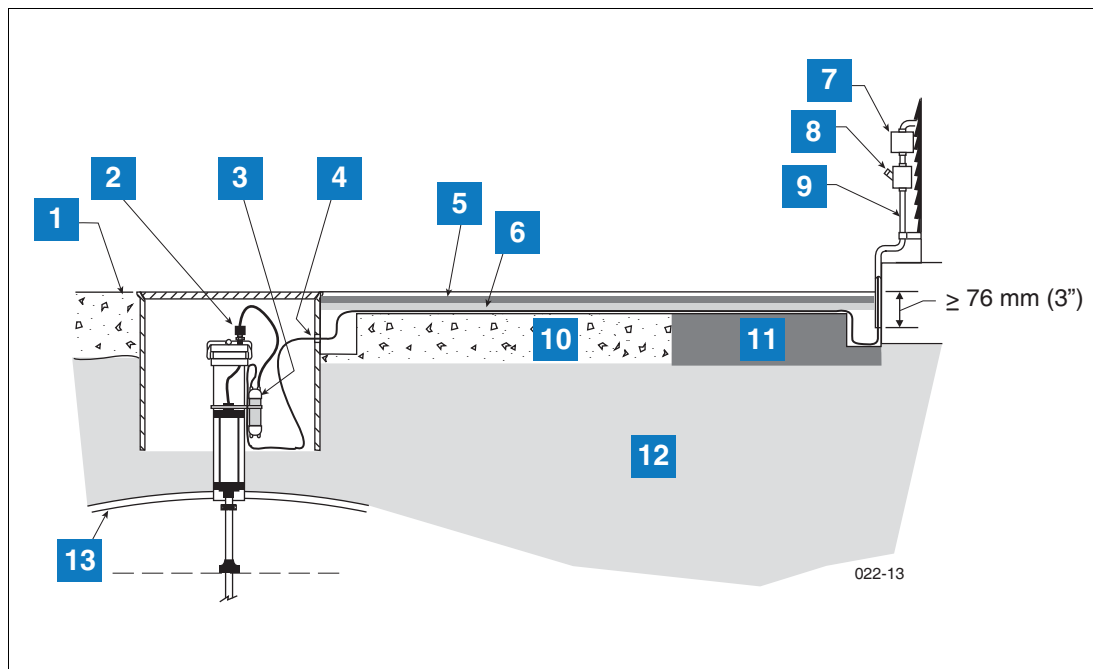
Exemplo de cabeamento de sonda com cabo diretamente enterrado
